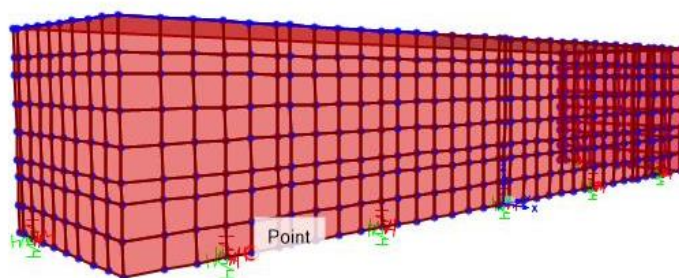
Vista 3D del modello agli elementi finiti della spalla
